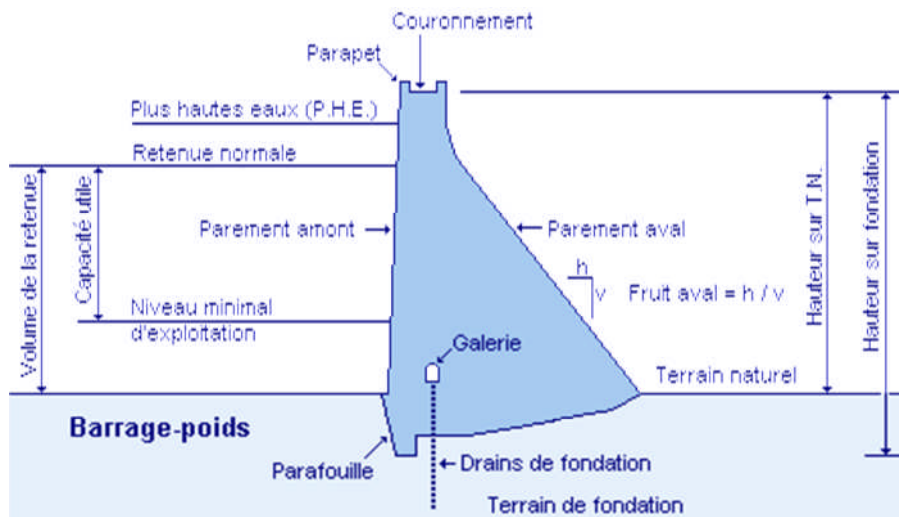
Paramètres d'un barrage poids et position du voile de drainage
